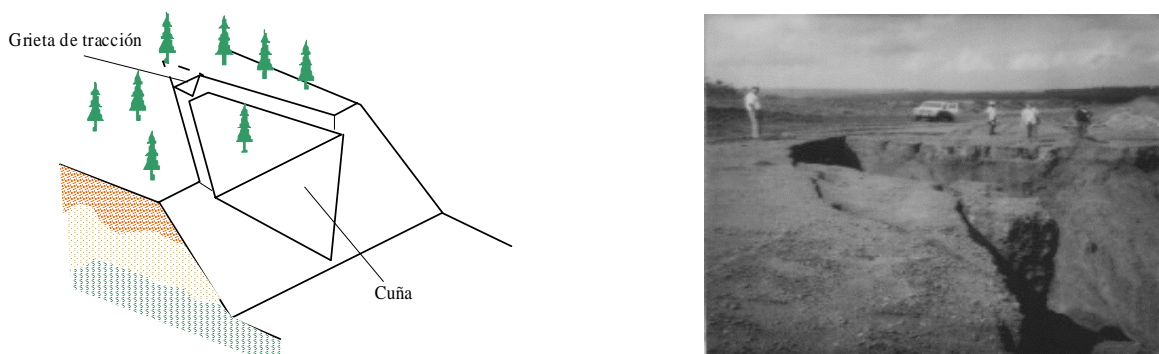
Deslizamientos en forma de cuña desarrollado en cortezas lateríticas residuales. Los planos que conforman la cuña son planos de grietas relícticas presentes en la corteza. (Guardado/Almaguer 2003)
